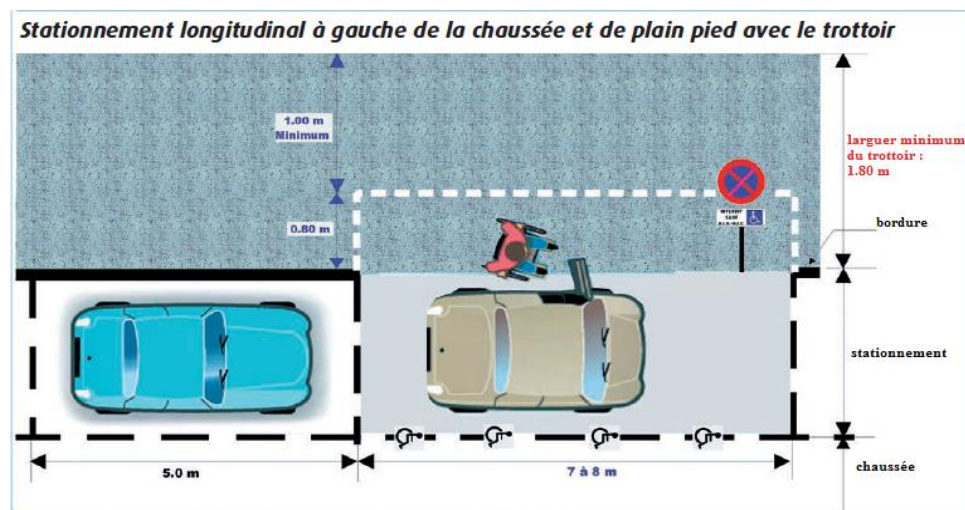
Stationnement longitudinal à gauche de la chaussée.
